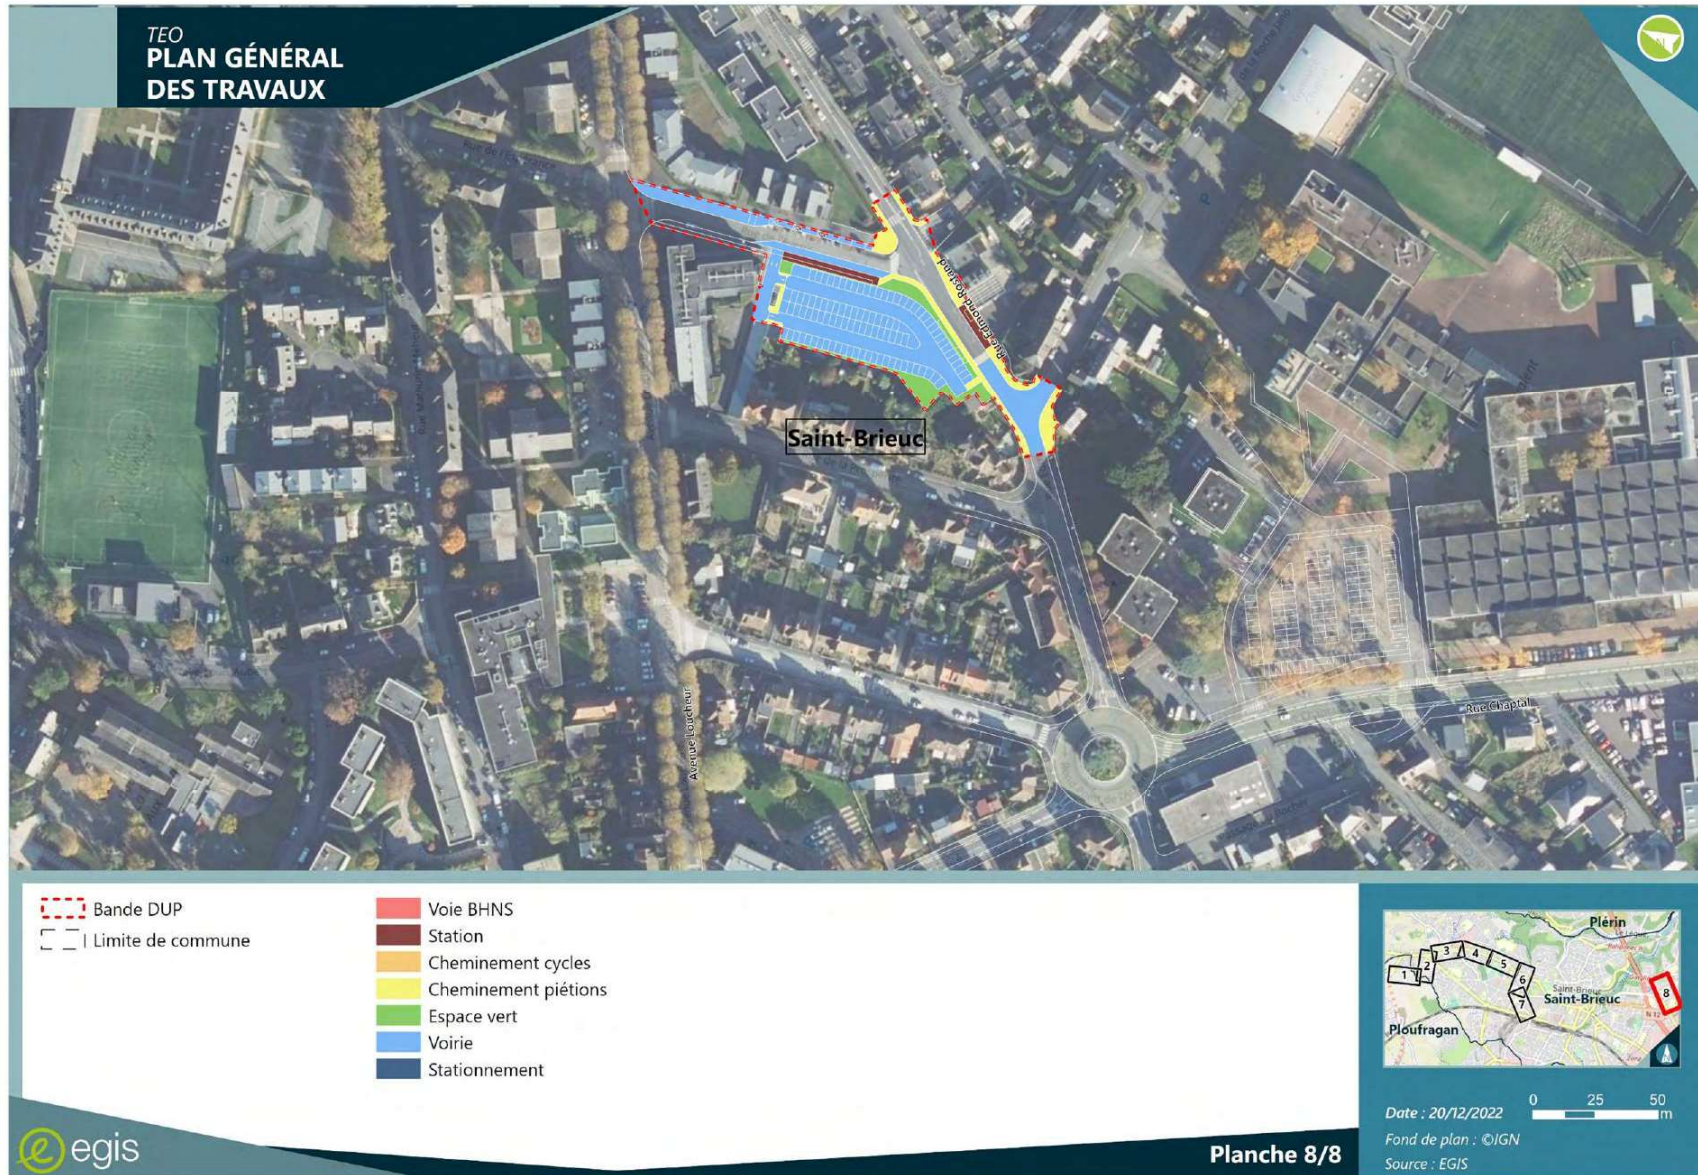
Plan général des travaux 8/8 (Source : EGIS)
